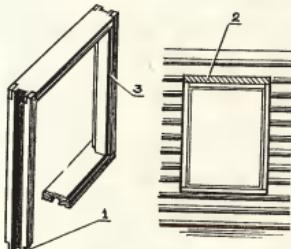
Установка коробки: 1 — шип; 2 — зazor; 3 — четверть.
